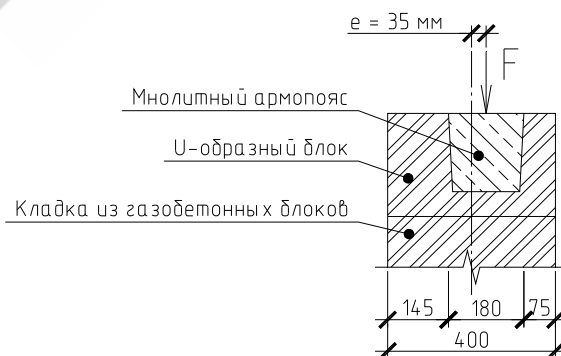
Схема приложения нагрузки на стену при толщине стены 400 мм.
